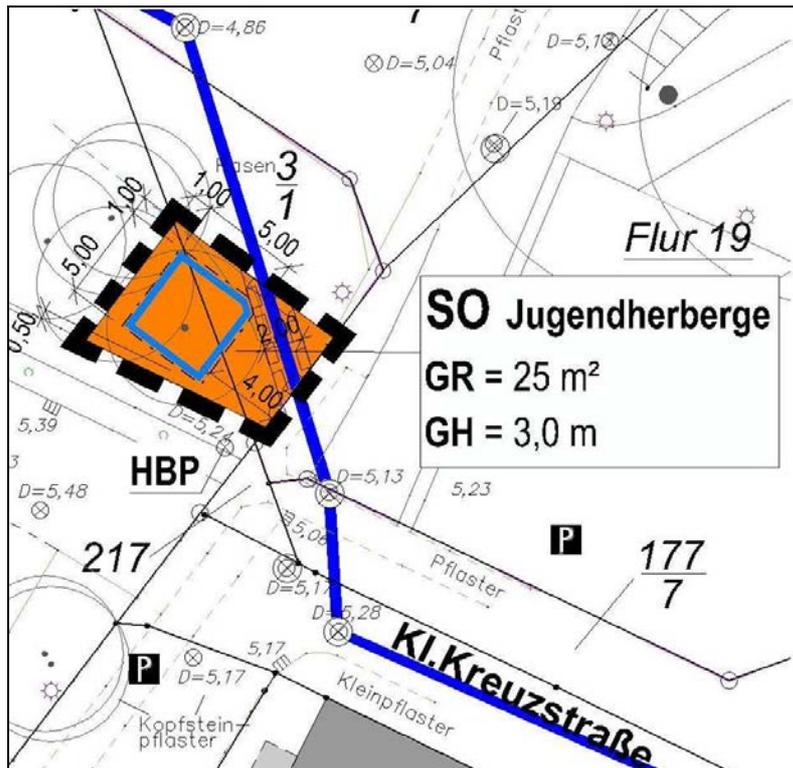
Planzeichnung mit Darstellung der vorhandenen Leitungstrasse (Hauptsammler Regenwasser)
